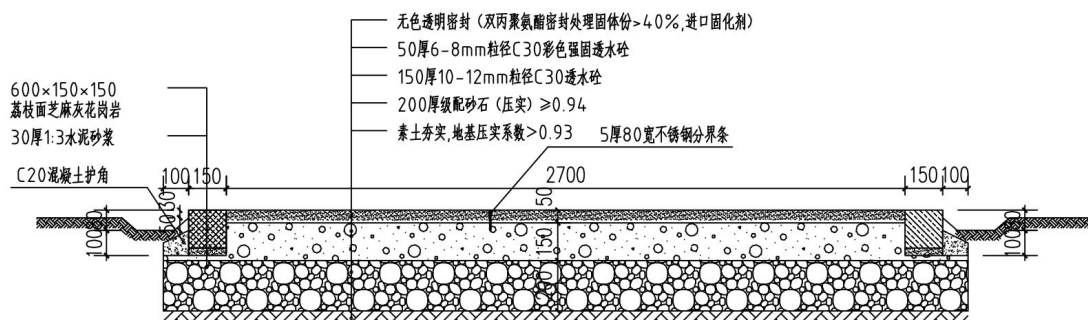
3 米绿道（彩色透水混凝土）标准段剖面图
